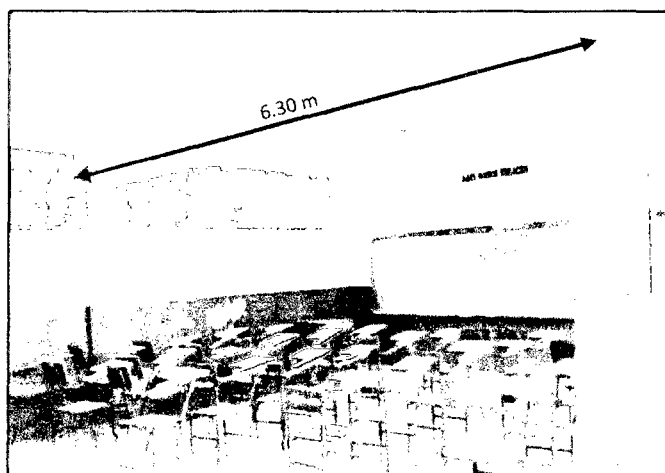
Pabellón 1. Separación máxima entre los apoyos laterales de la viga.
